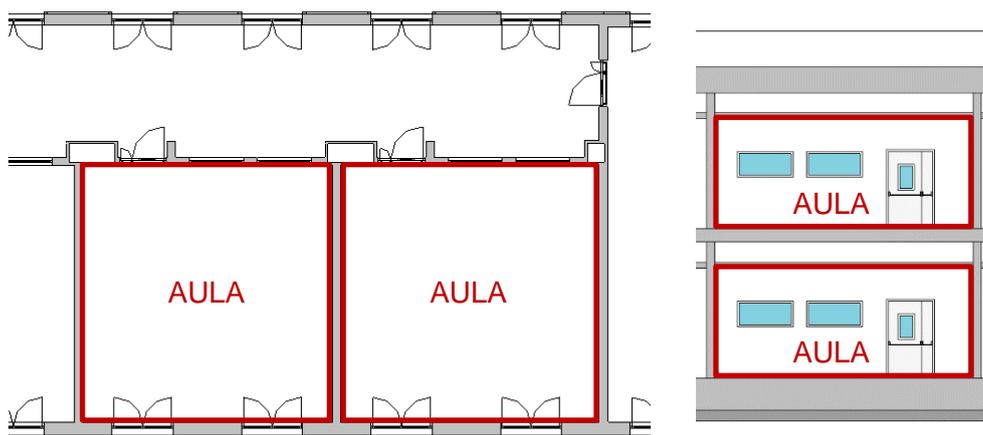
Individuazione del locale oggetto di verifica: aule (pianta e sezione)
